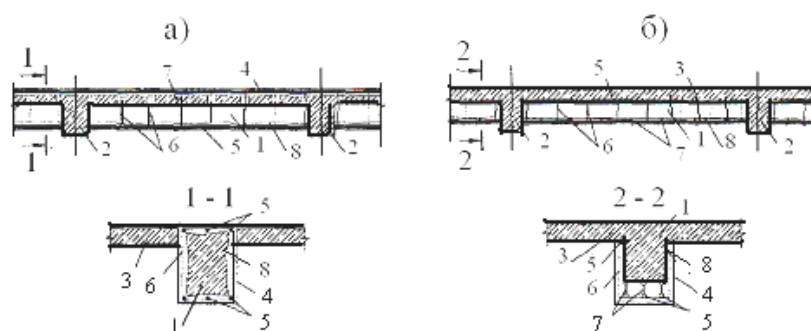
Усиление главных балок монолитного перекрытия с помощью устройства железобетонной обоймы (а) или рубашки (б):
